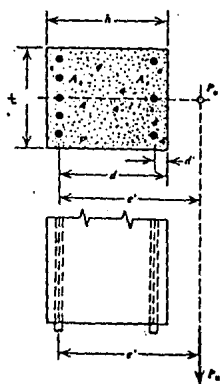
Sección rectangular de concreto con varillas en los extremos.
